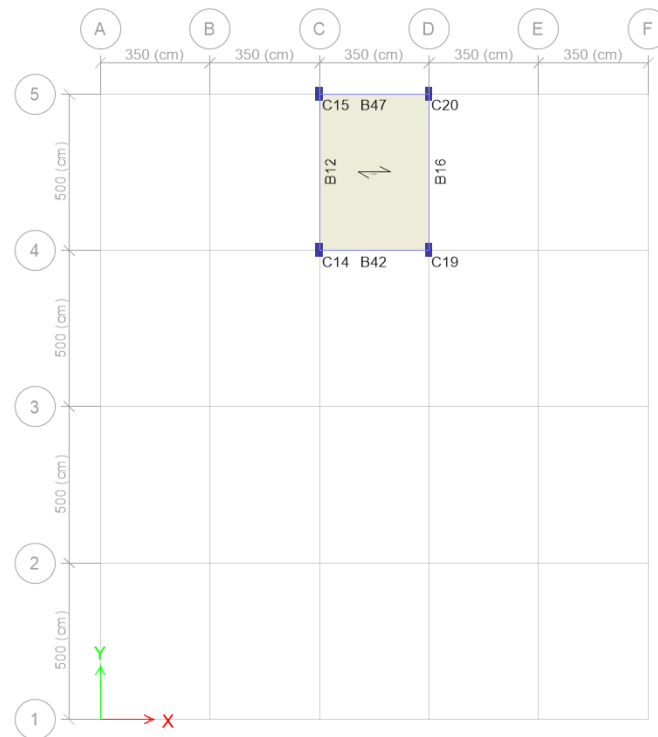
Planta Nivel Techo Escalera, Elev. +11.56 m Caso 5 y 6.
